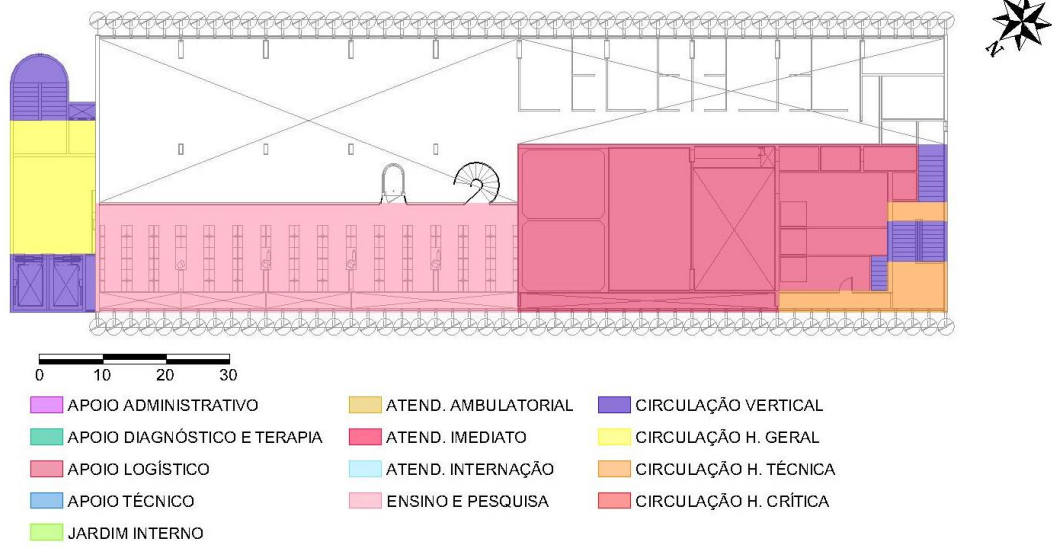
Setorização Edifício Sede, mezanino do 11º pavimento.
